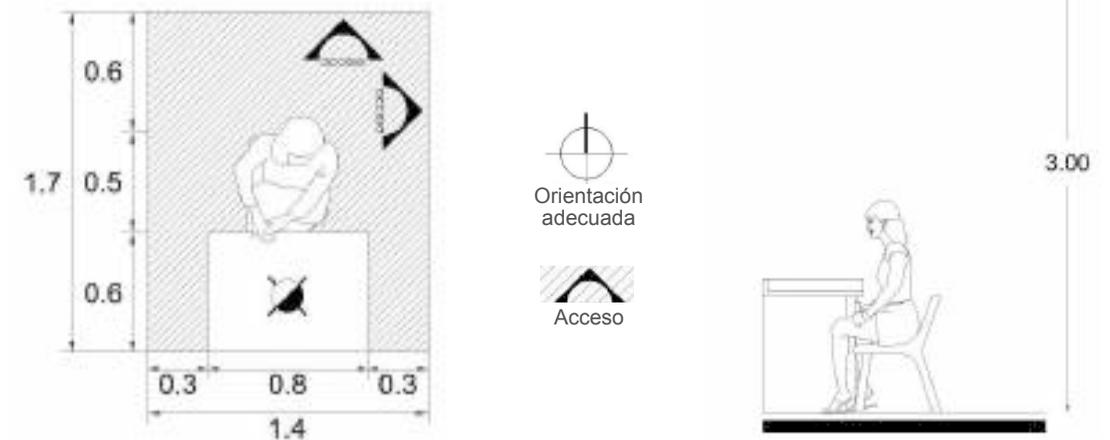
Elaboración del Autor. Gráfico en planta y alzado de la actividad de trabajo en área individual
